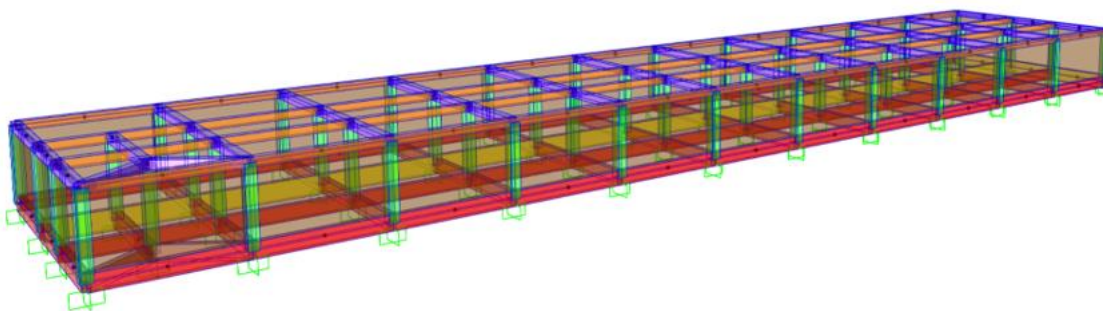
Sistema de isolamento com a grelha de vigas de travamento e parede de contenção
